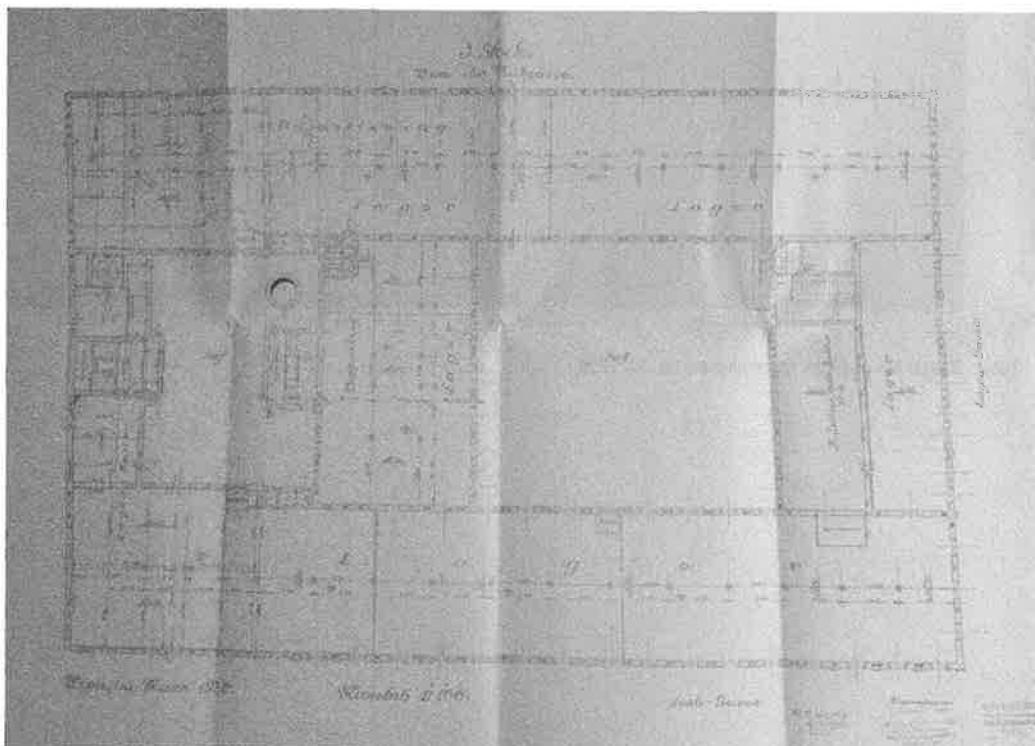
Grundriss 3. Obergeschoss (2)
